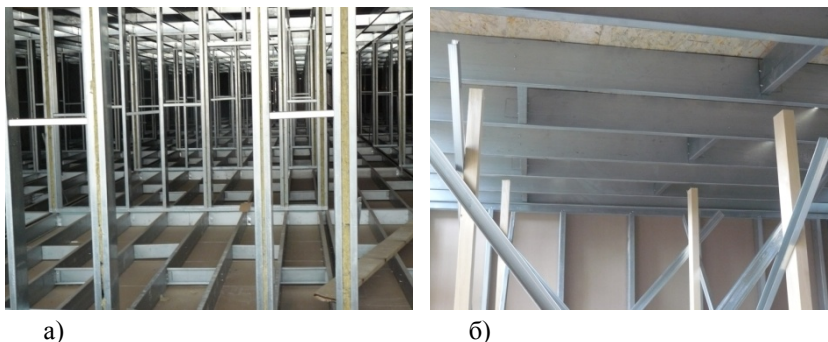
Балки перекрытия: а) общий вид; б) испытываемые балки Б-1 и Б-2
